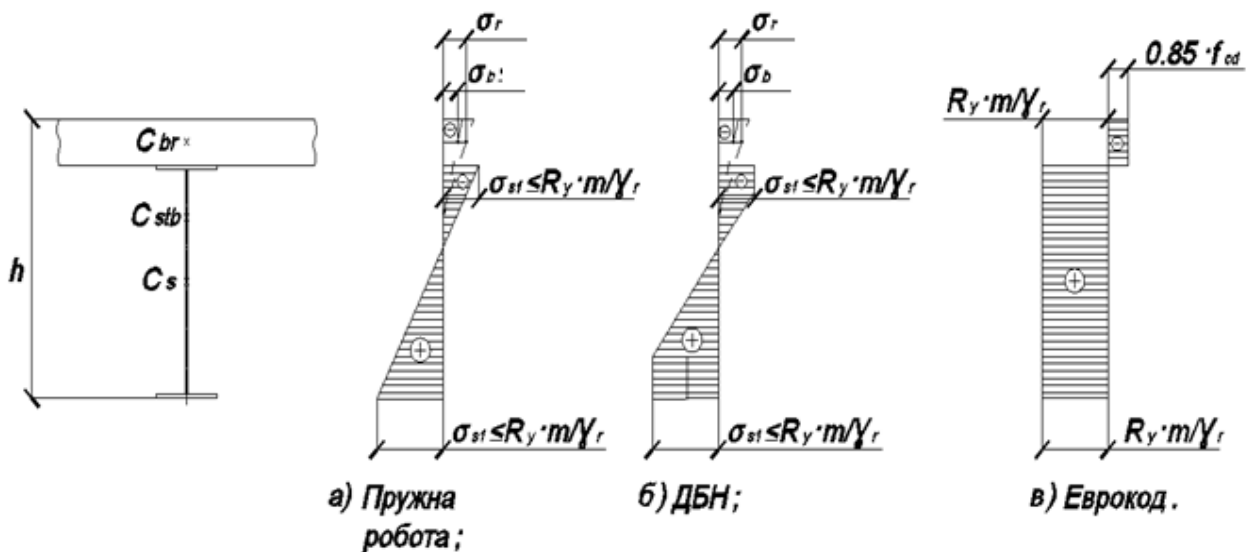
Нормальні напруження у сталезалізобетонному поперечному перерізі головної балки, що сприймає додатній згинальний момент
